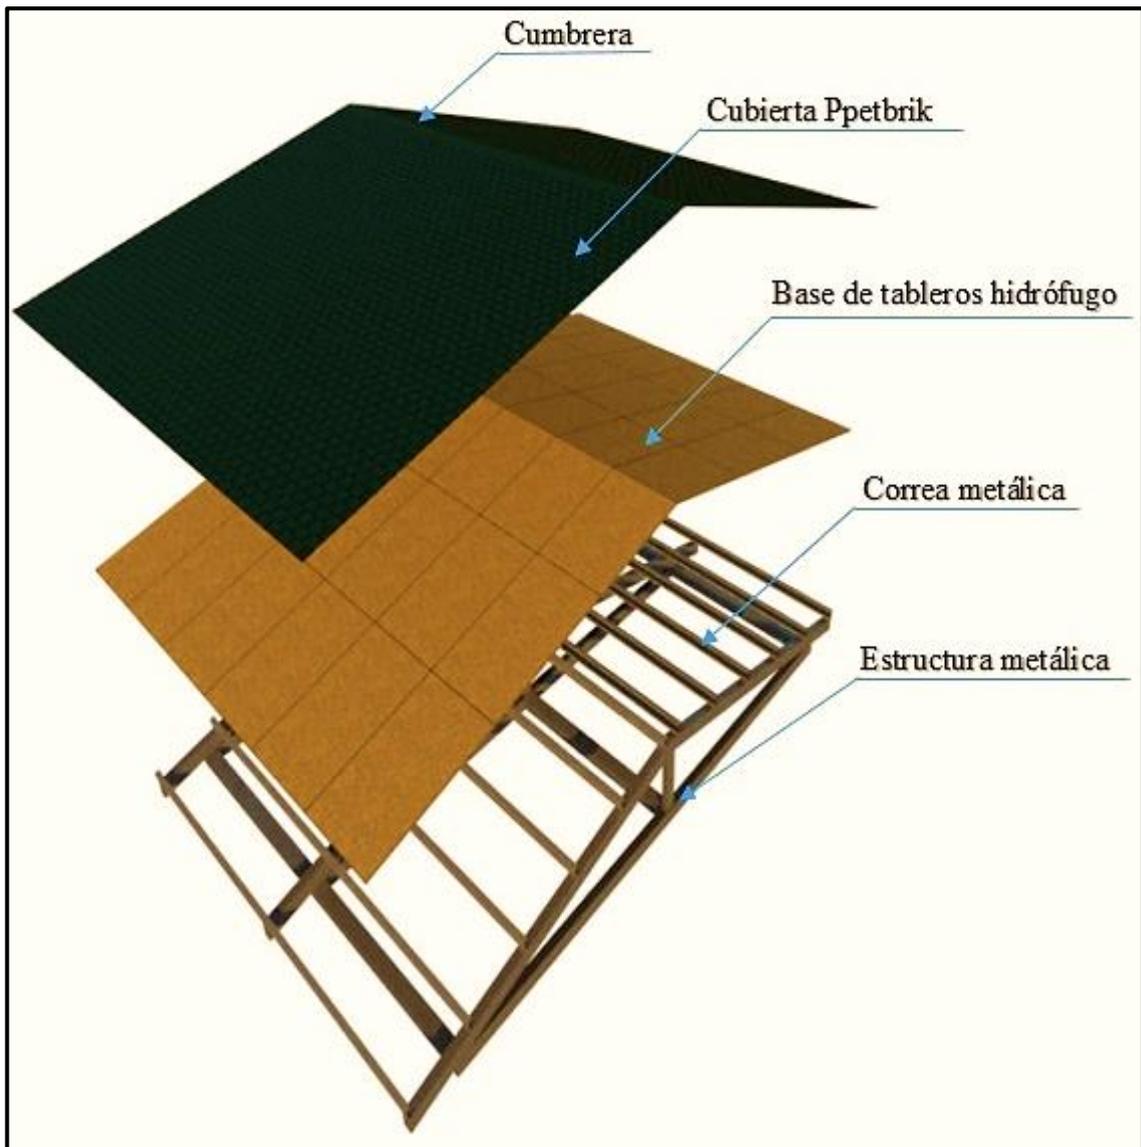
Desglosamiento de estructura de cubierta Ppetbrik.
